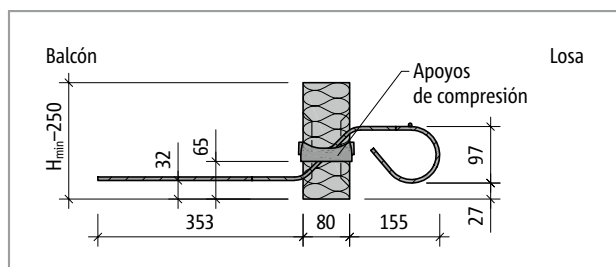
Schöck Isokorb® T tipo Q-V1 hasta Q-V5 en R0: Sección del producto
